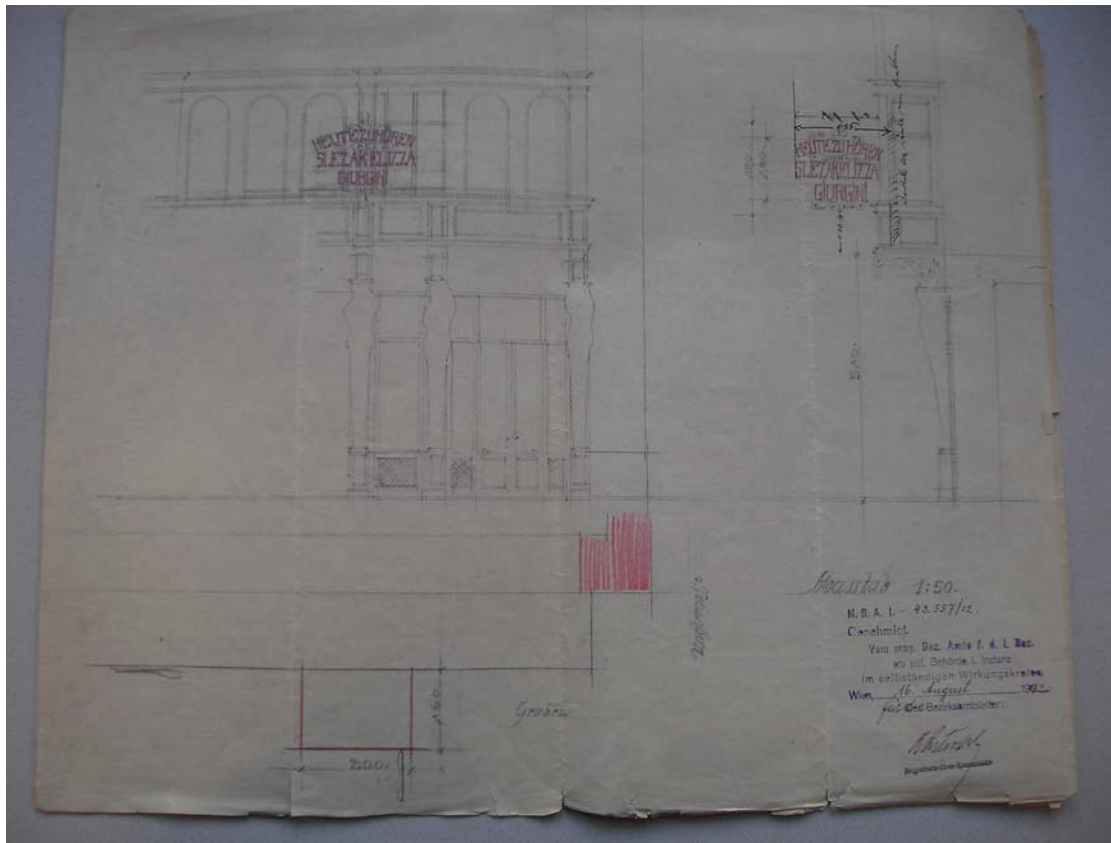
Einreich- / Ergänzungsplan zum Haus Liebig, 16.08.1912, zur Anbringung einer temporären Reklametafel.
